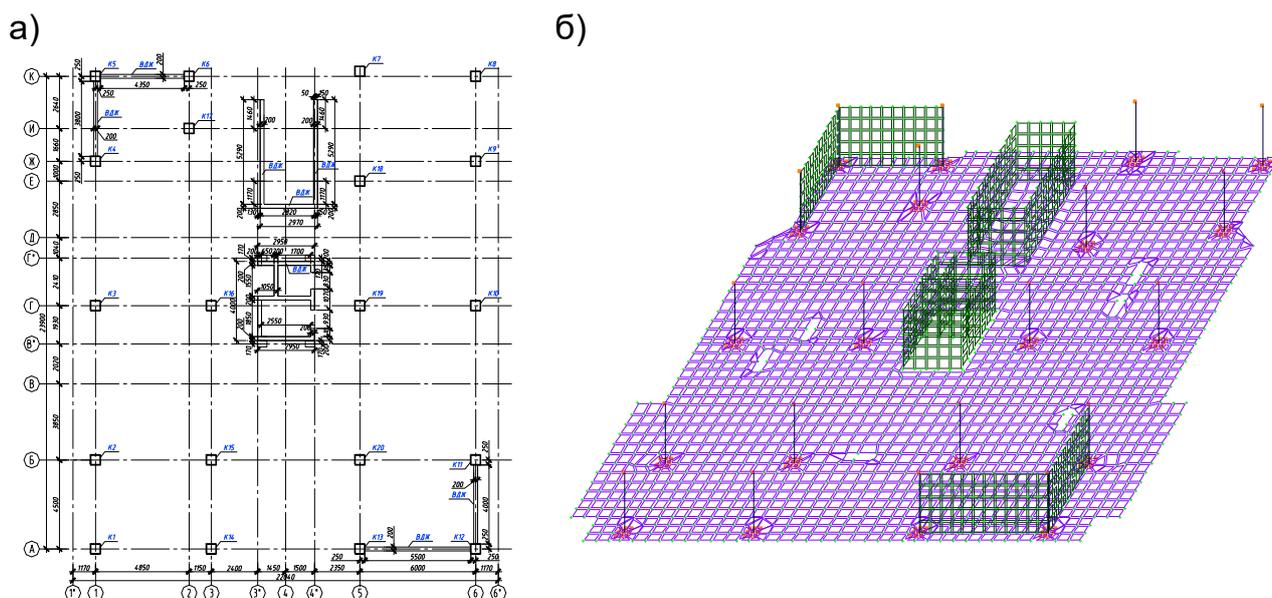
План здания по 2-му варианту (а) и разработанный фрагмент КЭМ
